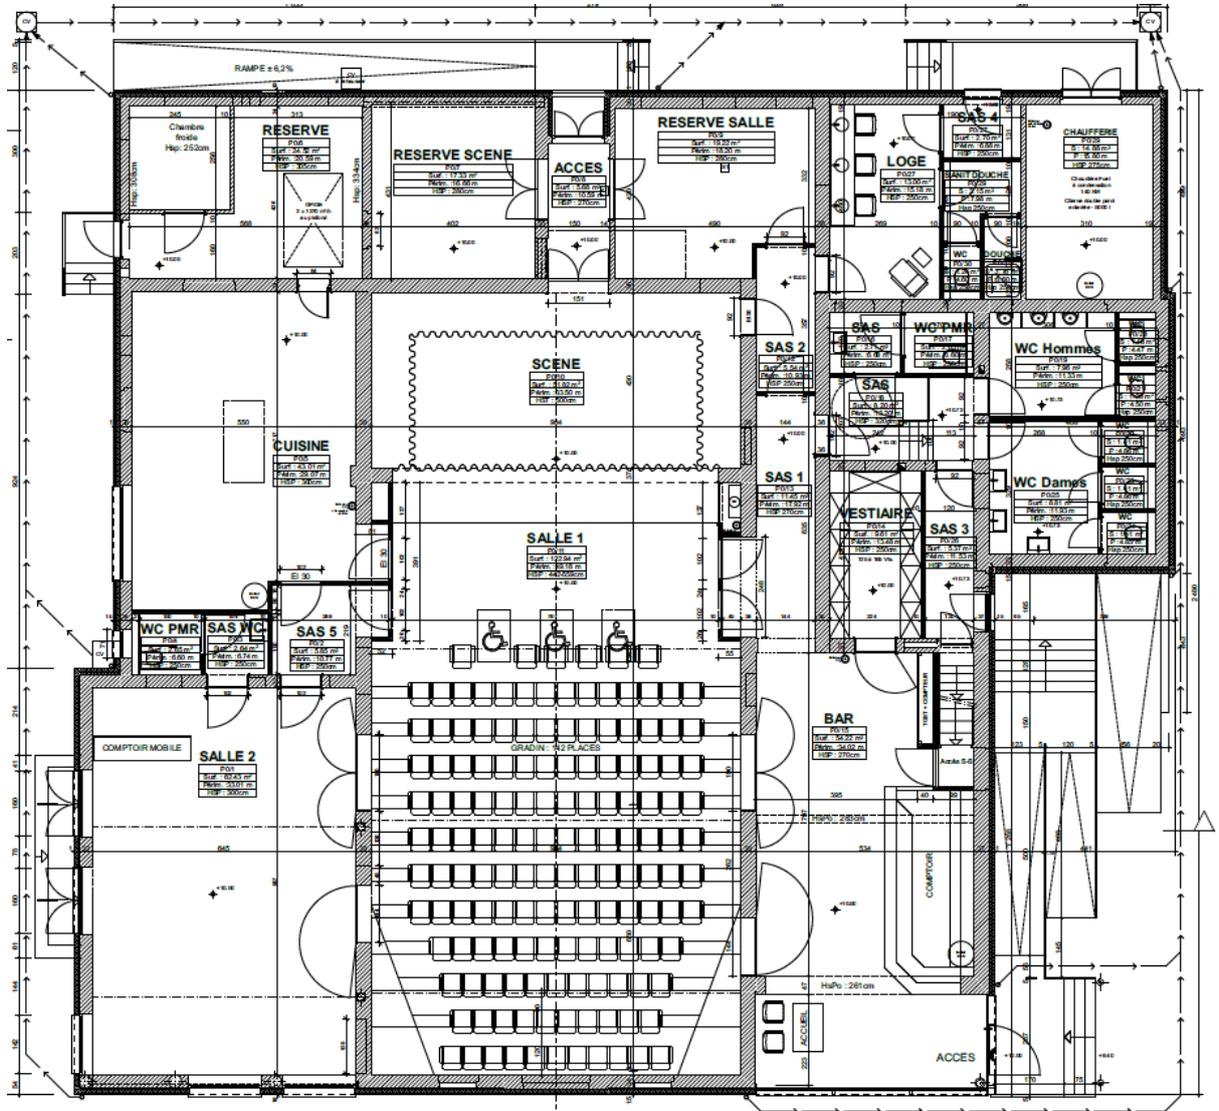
Rénovation de la salle des Thuyas – rez-de-chaussée
